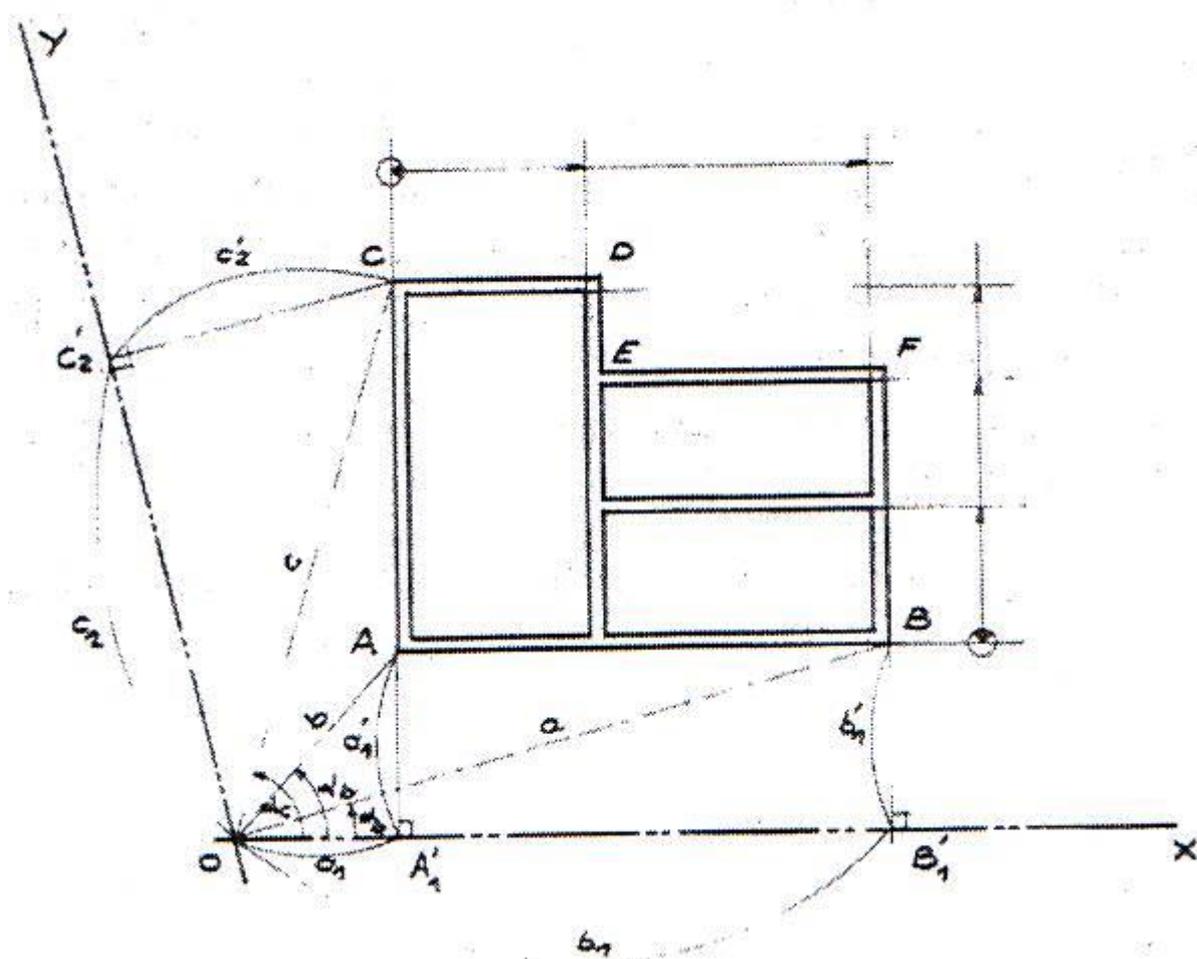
Plan d'implantation à partir d'un point fixe et d'un axe X
